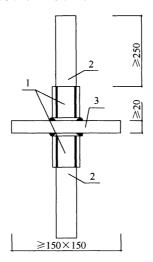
1 钢筋连接套筒试件 1—钢筋连接套筒; 2—钢筋; 3—连接板
